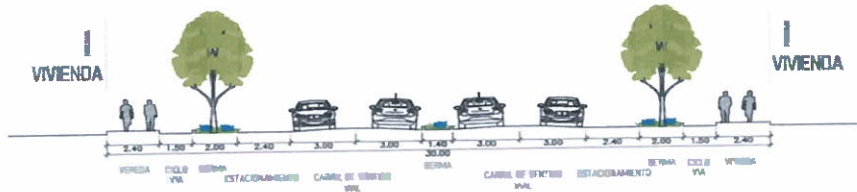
PLANO VIALES EQUIPO TECNICO
